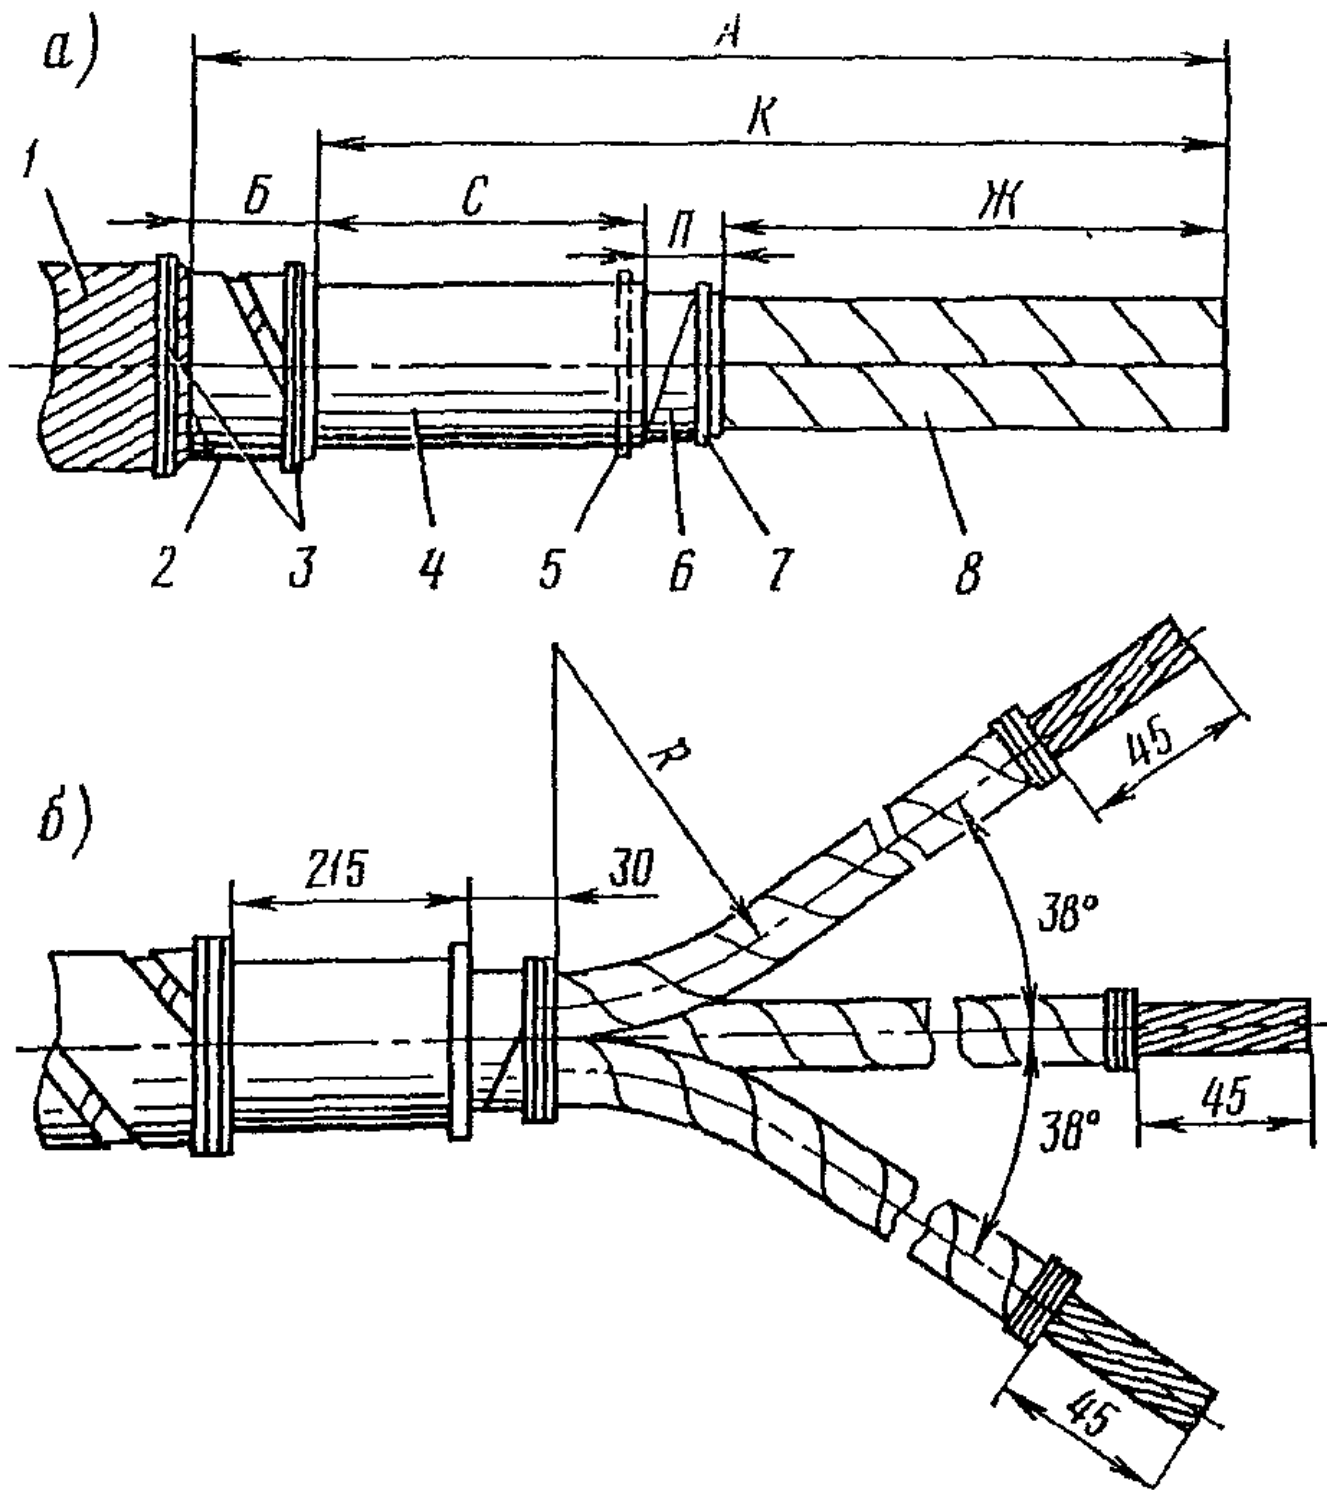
Разделка трехжильного кабеля с поясной изоляцией для монтажа муфты типа КН: а - удаление покрытов и оболочки; б - разводка жил кабеля; 1 - наружный покров; 2 - броня; 3 - проволочный бандаж; 4 - металлическая оболочка; 5 - разбортка; 6 - поясная изоляция; 7 - бандаж из хлопчатобумажной пряжи; 8 - фазная изоляция
